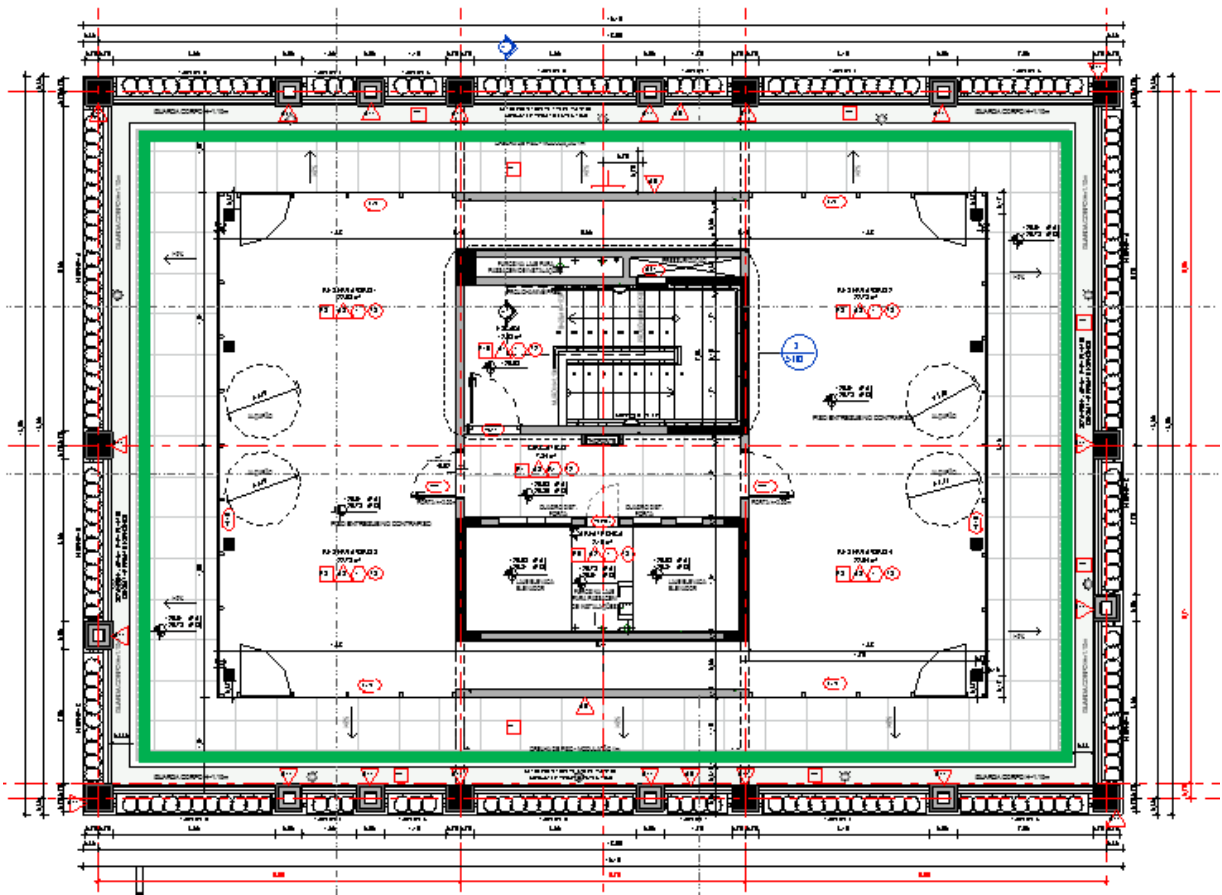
Relatório Compatibilização DWF – Planta Baixa Drenagem do pavimento Ático passando pelo 6º pavimento.
